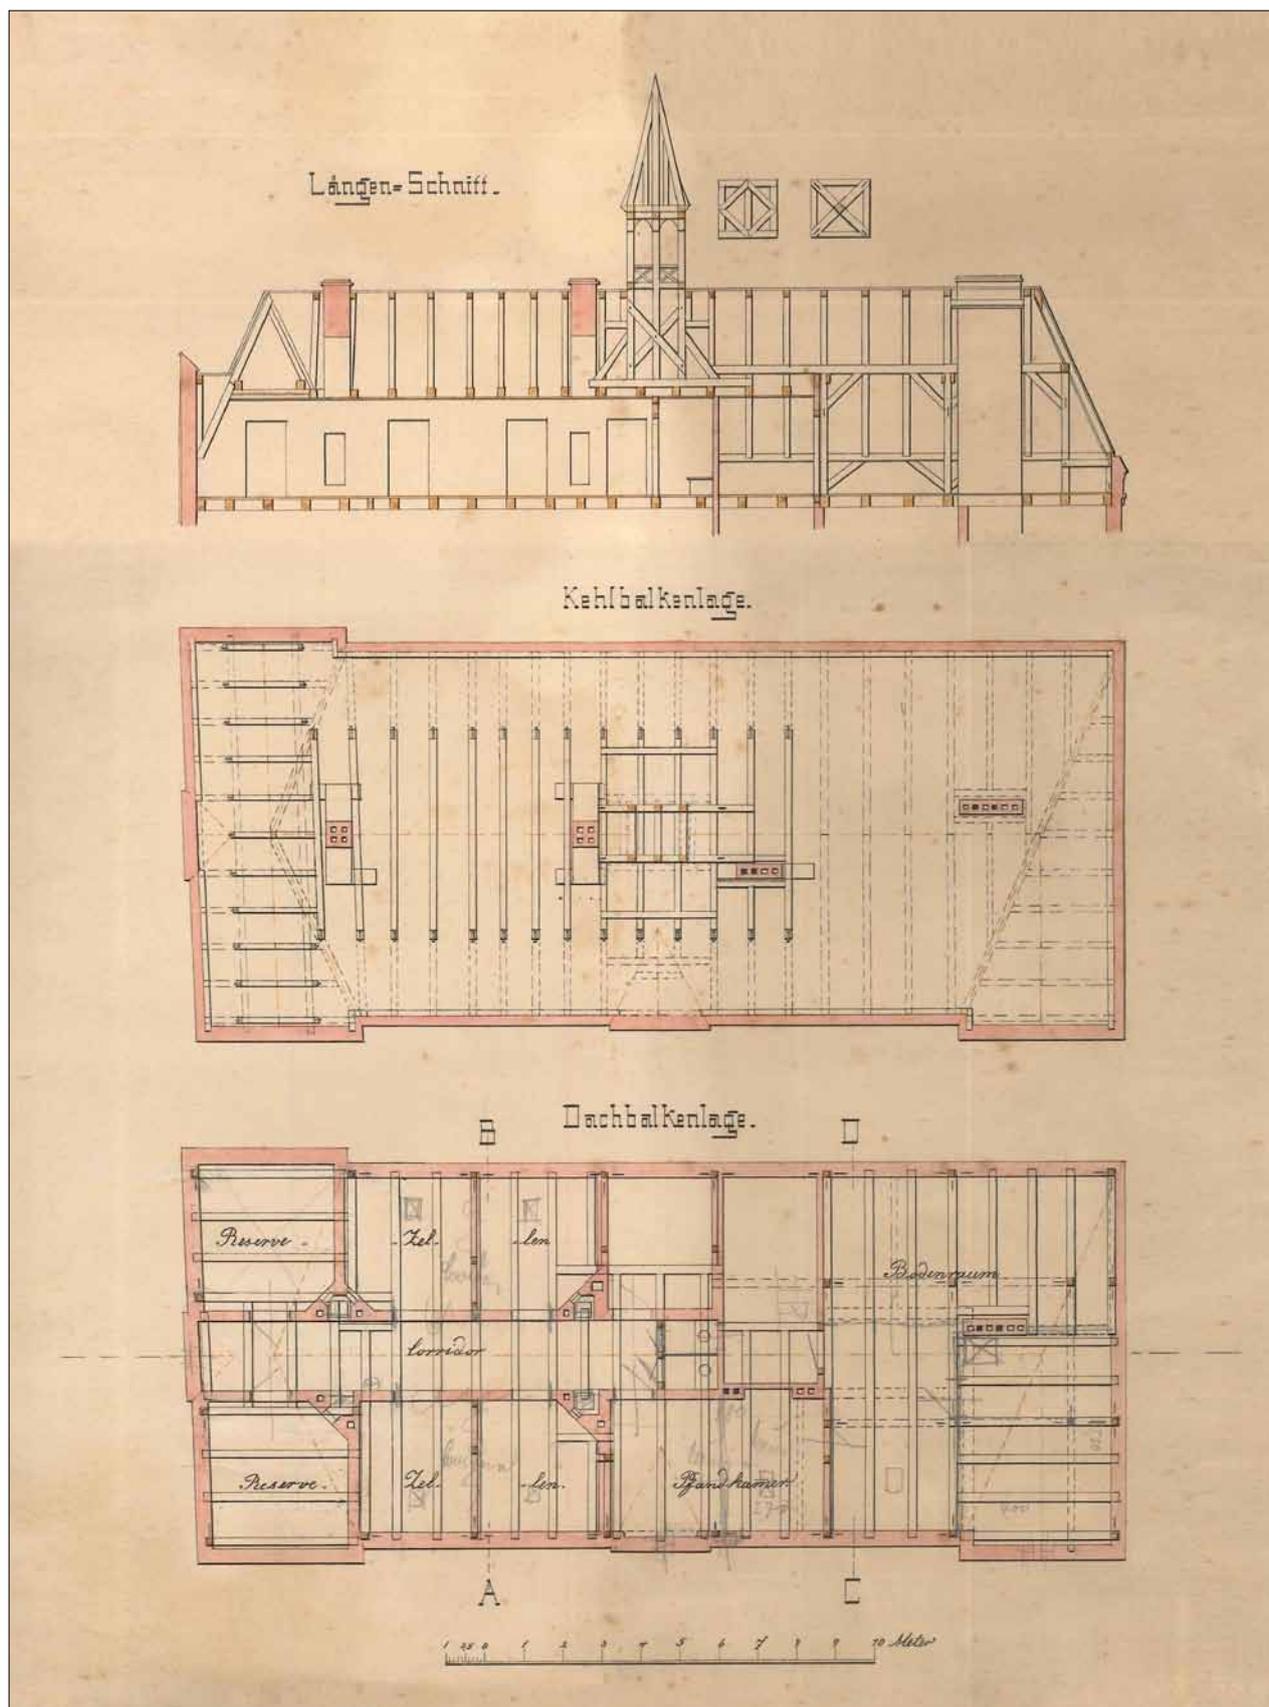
Greifswald, Baderstraße 24. Planzeichnungen für das 1879 errichtete Polizeigefängnis. Unten das Dachgeschoss mit Dachbalkenlage und Binnenunterteilung, in der Mitte die Sparrenlage, oben ein Längsschnitt durch das Dach. Der Entwurf verdeutlicht die konstruktiven und räumlichen Unterschiede zwischen nördlichem (links) und südlichem Dachbereich (vgl. Abb. 21). Abbildung: StAG Pläne B 922 (Ausschnitt)
